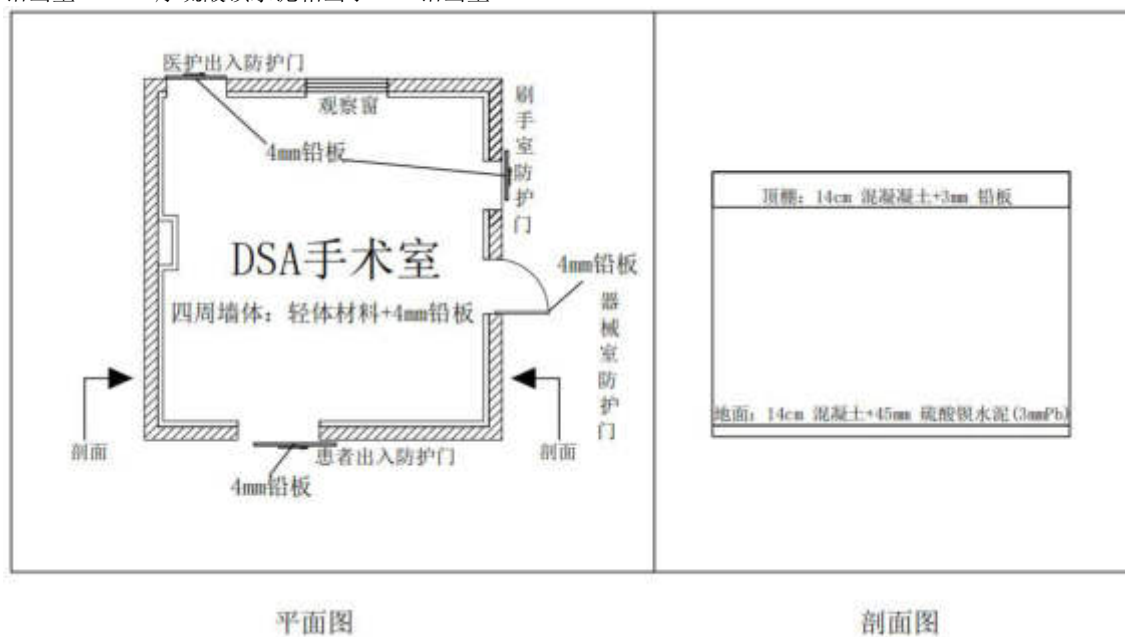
本项目 DSA 手术室四周墙体防护结构平面图及剖面图
